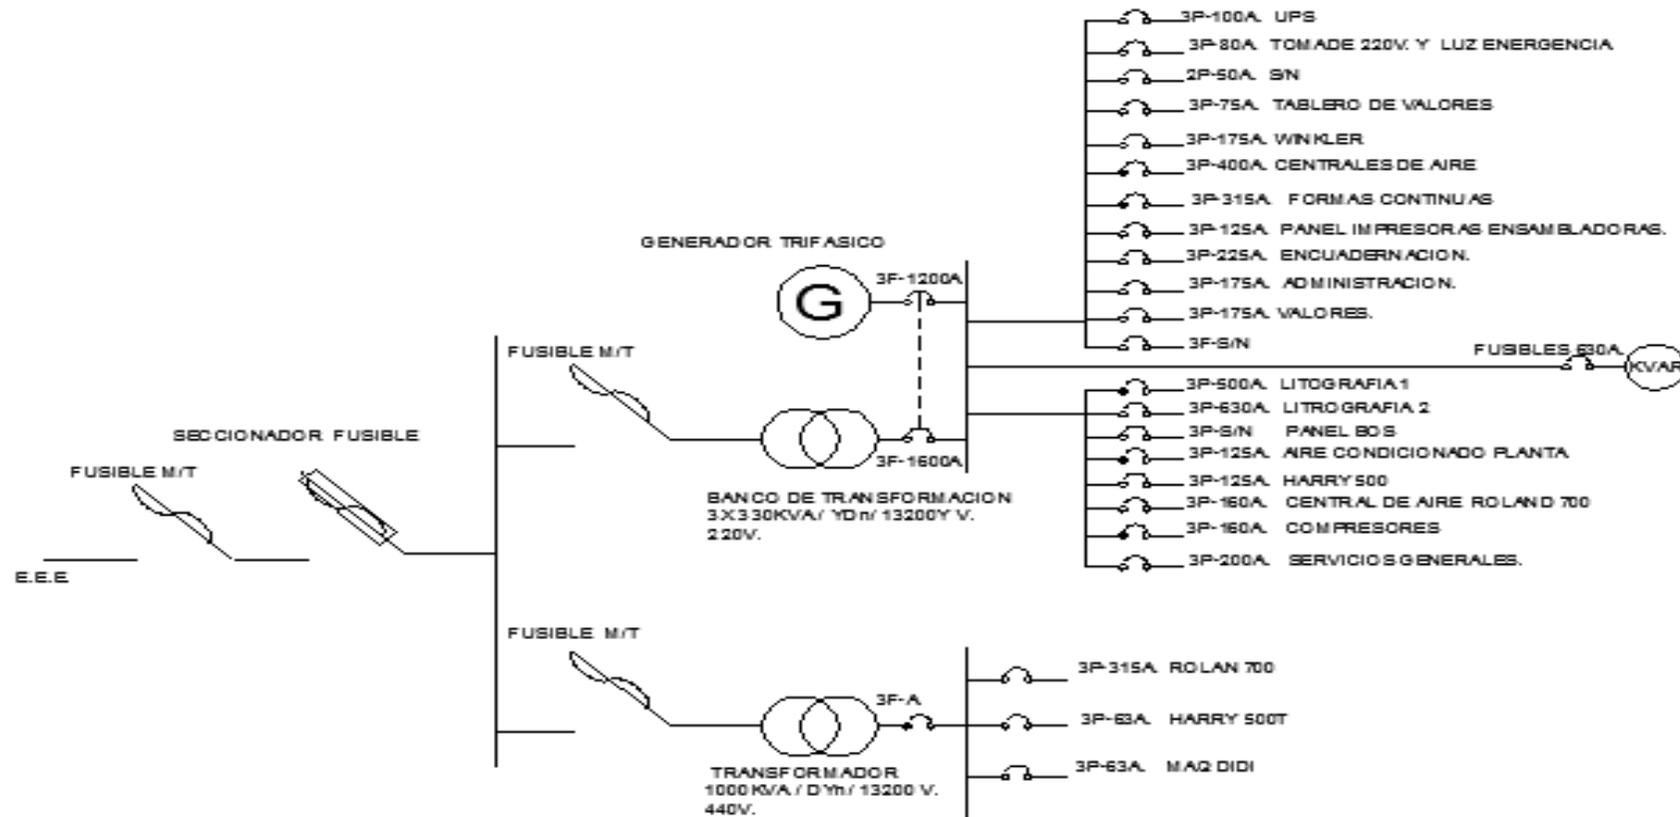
Plano eléctrico Unifilar de las instalaciones de SENEFELDER C.A. Fuente: Autor
